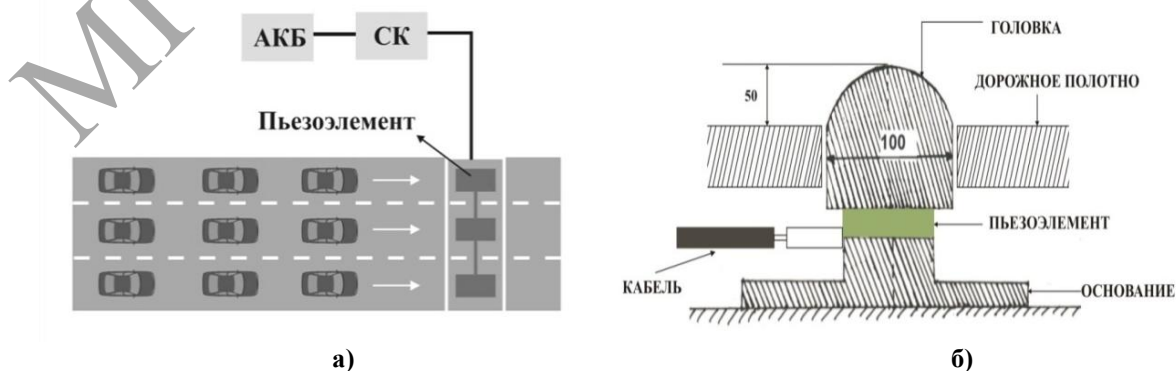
а) Полотно дороги с пьезоэлементами; б) Приспособление для сборки электрического заряда
